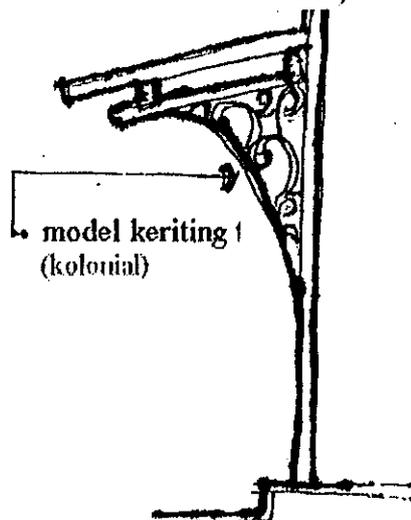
Selasar pada bangunan Hamongpraja. Terdapat liang besi tuang. (Konstruksi kolonial Belanda)
